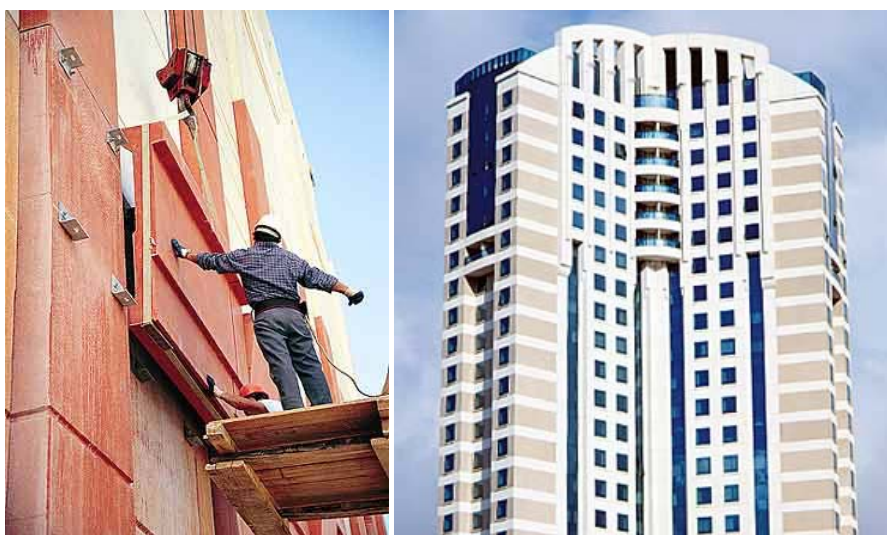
Painel de fachada sendo montado, e fachada de edifício em São Paulo com este tipo de painel
